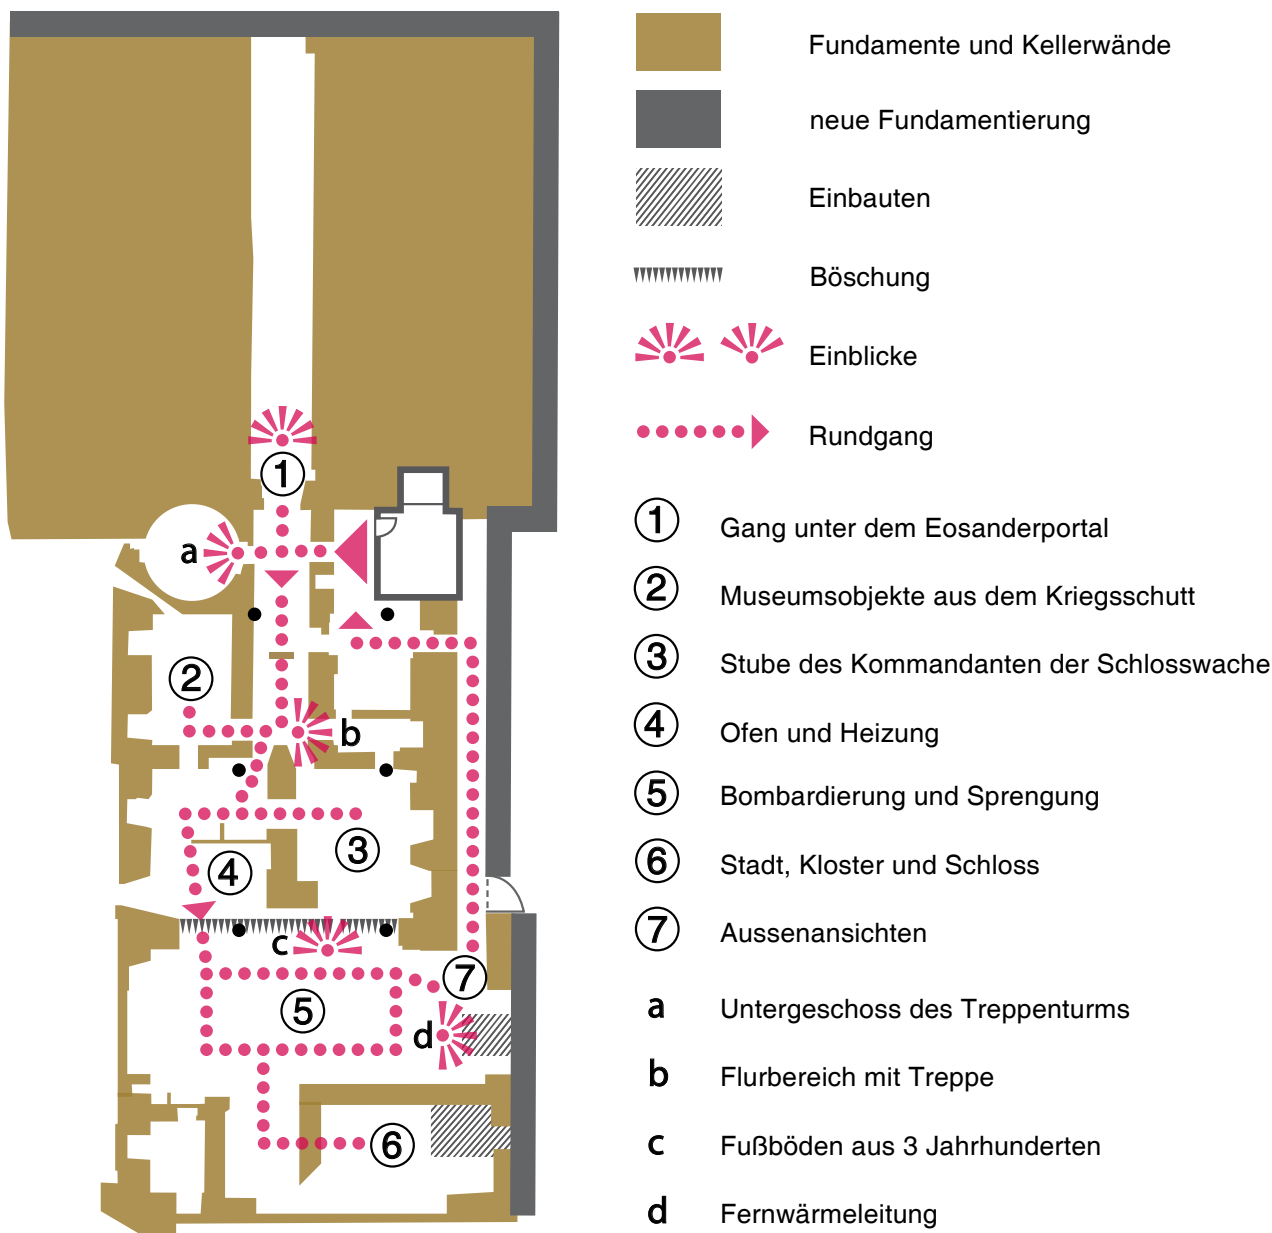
Gesamtplan mit Rundgang in den Kellern des Berliner Stadtschlusses.
